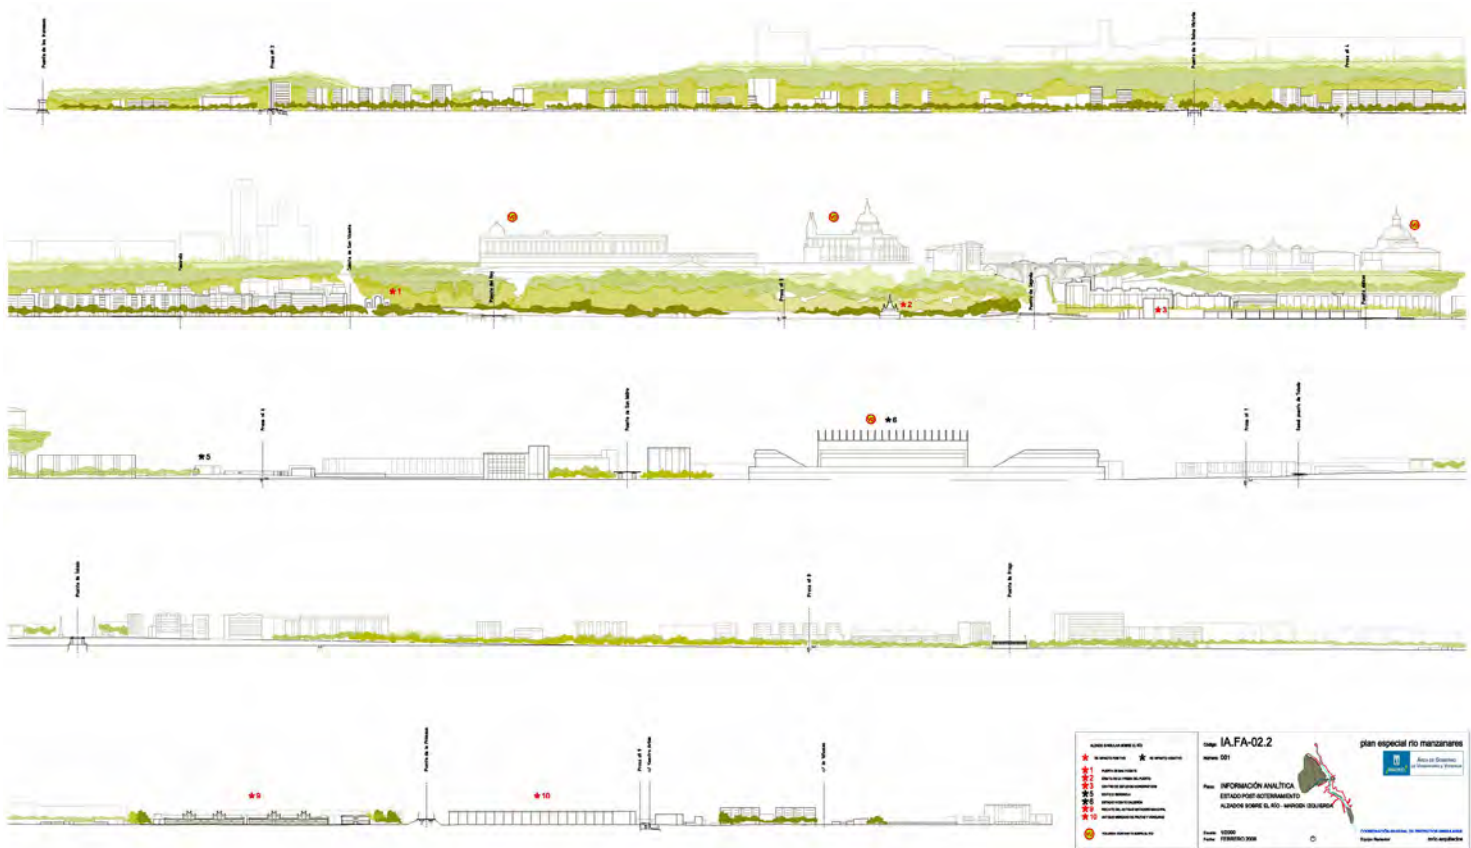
Alzados sobre el margen izquierdo. E: 1/2000. Plan Especial Río Manzanares, MRío Arquitectos, febrero 2008. (Fuente: Ayuntamiento de Madrid).
